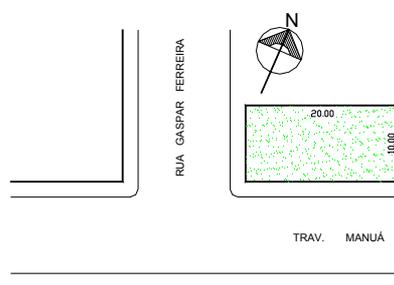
Planta Original da Área Verde 7 do CHSB
